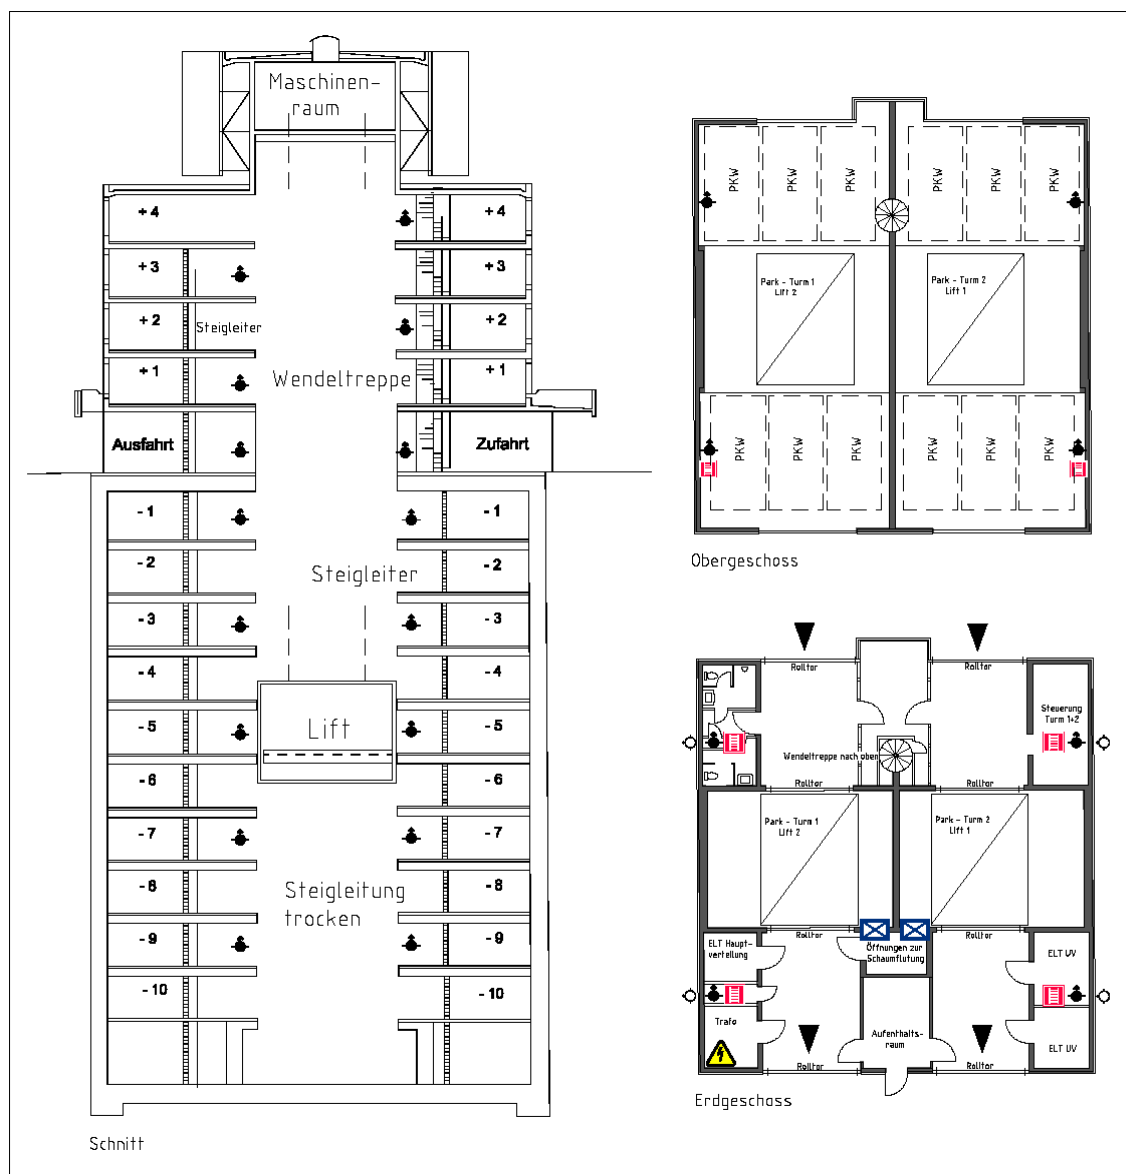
Schnitt und Grundrisse des Parksilo
